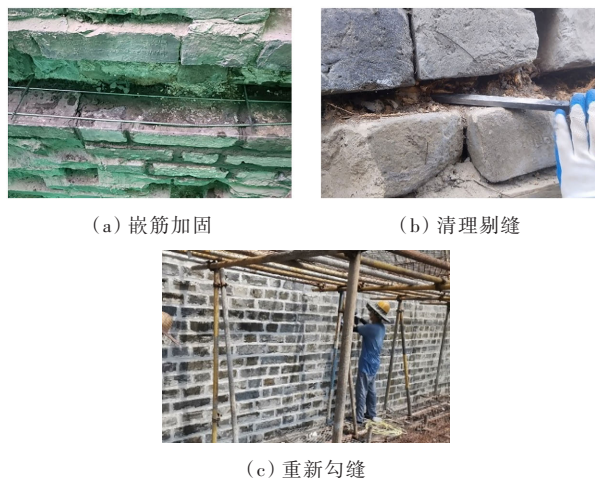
墙体裂缝病害(一般、轻微)修缮施工工
